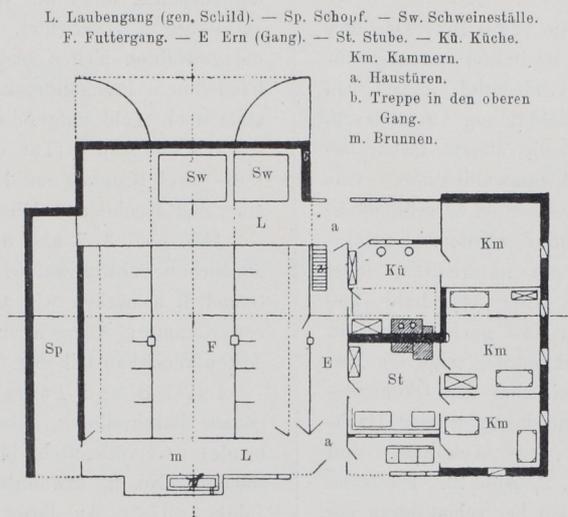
Erdgeschoß-Grundriß eines Bauernhofes in Willaringen.
